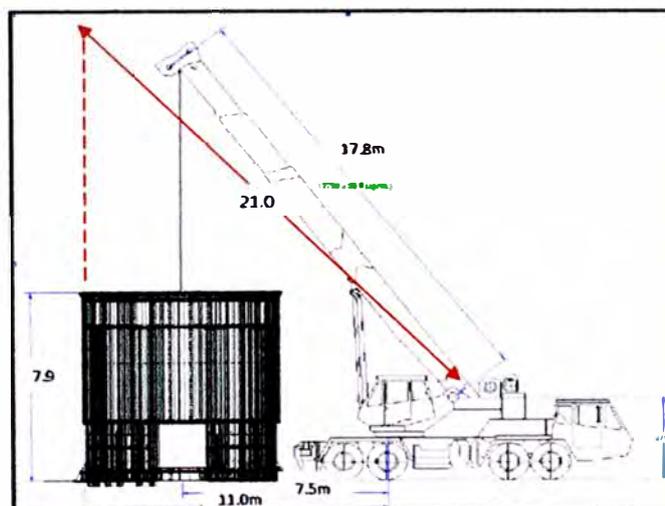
Dimensiones para el Montaje de la Estructura Soporte
